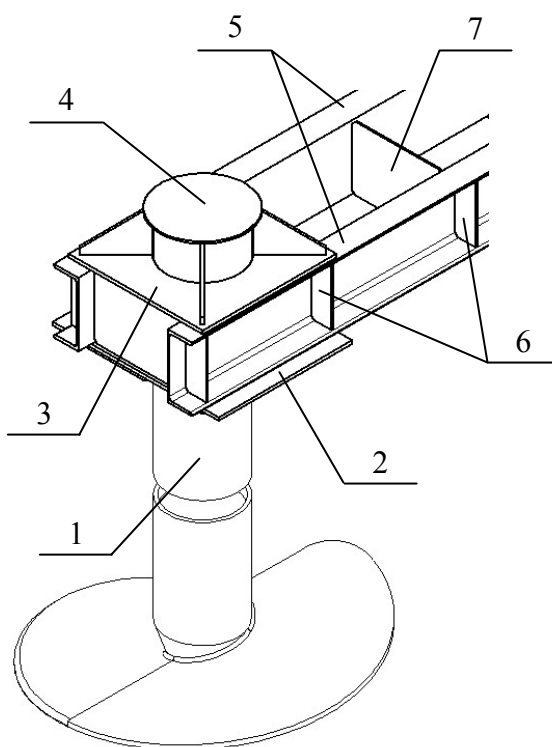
Общая схема конструктивных элементов фундамента:
